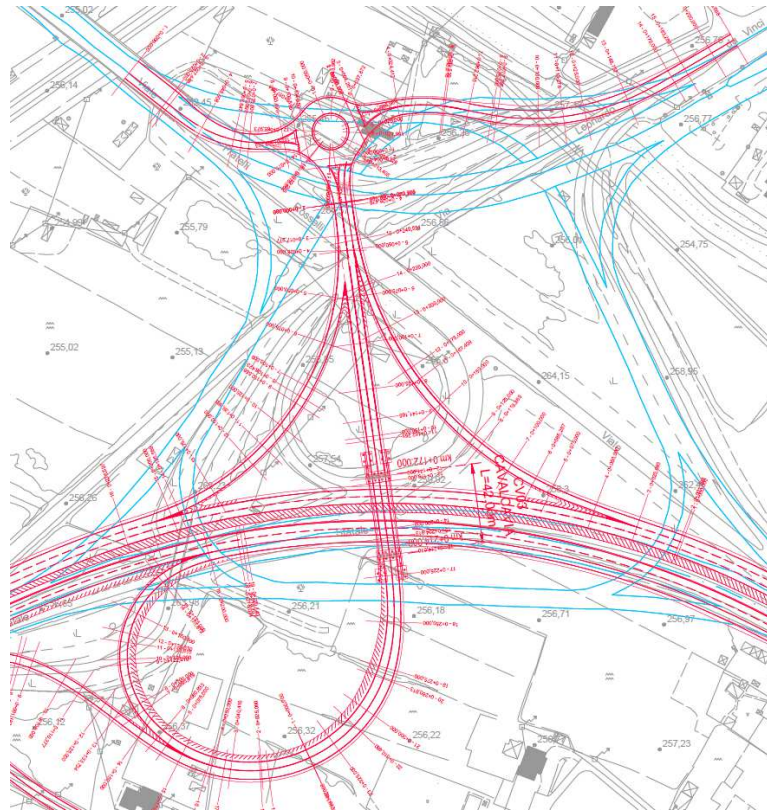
Svincolo “Arezzo” con le aree di cantiere - Estratti elaborato T00AM01AMBPL01 - Planimetria di confronto PP e PD 2022
